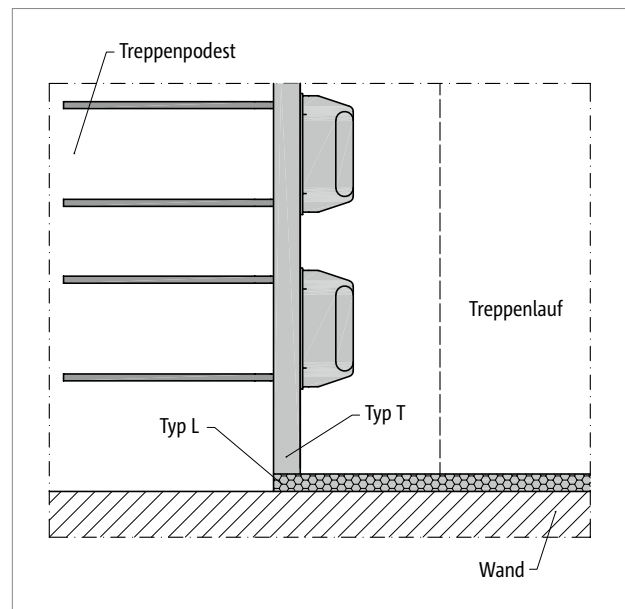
Schöck Tronsole® Typ T: Elementanordnung Detail B
